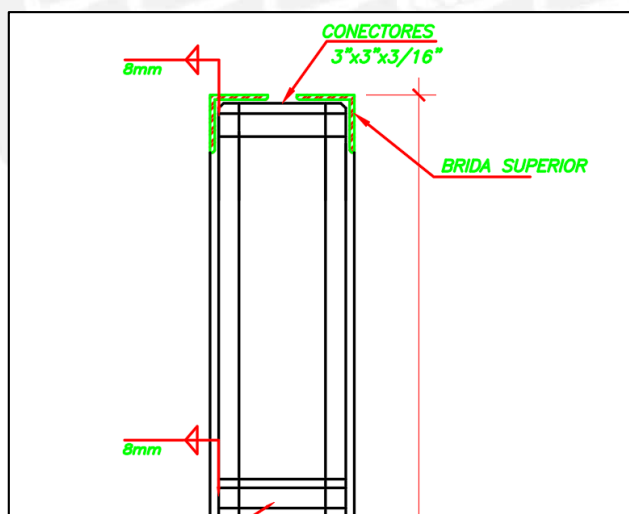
SIMBOLOGÍA DE SOLDADURA EN CONECTORES
